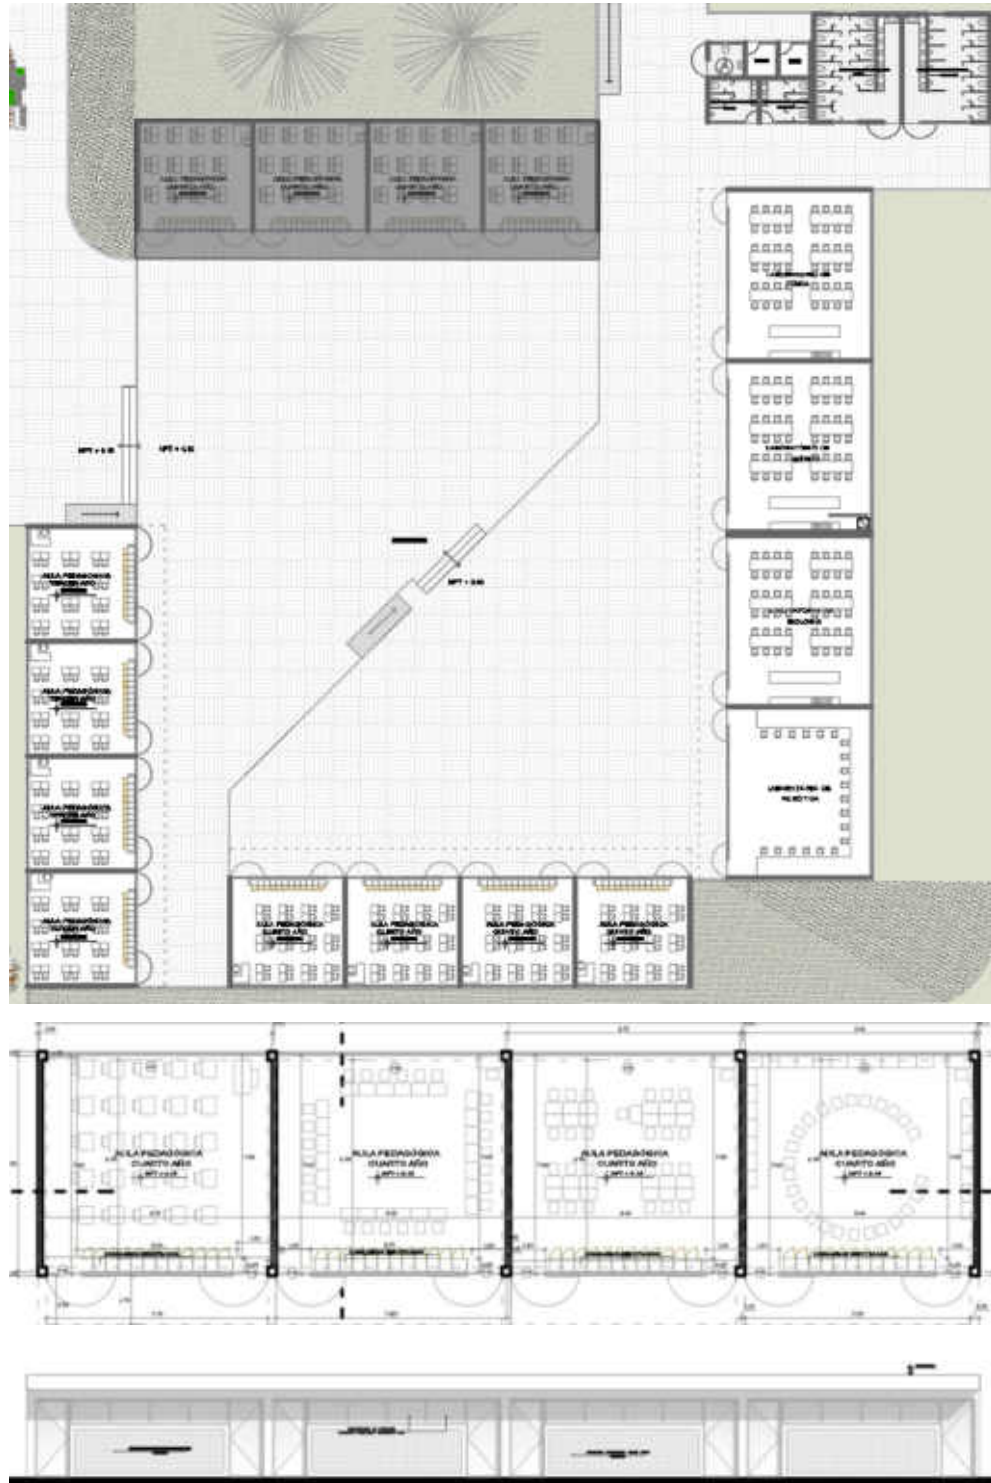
planta secciones y elevación de módulos pedagógicos., fuente elaboración propia.
